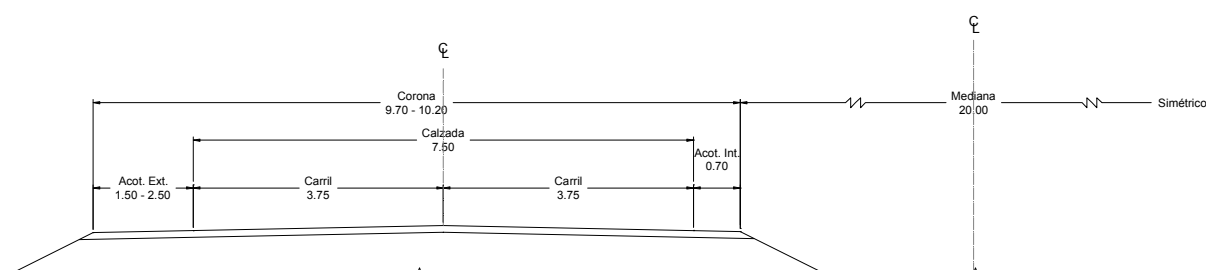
Sección transversal de la Autopista Cadereyta – Reynosa 40D
